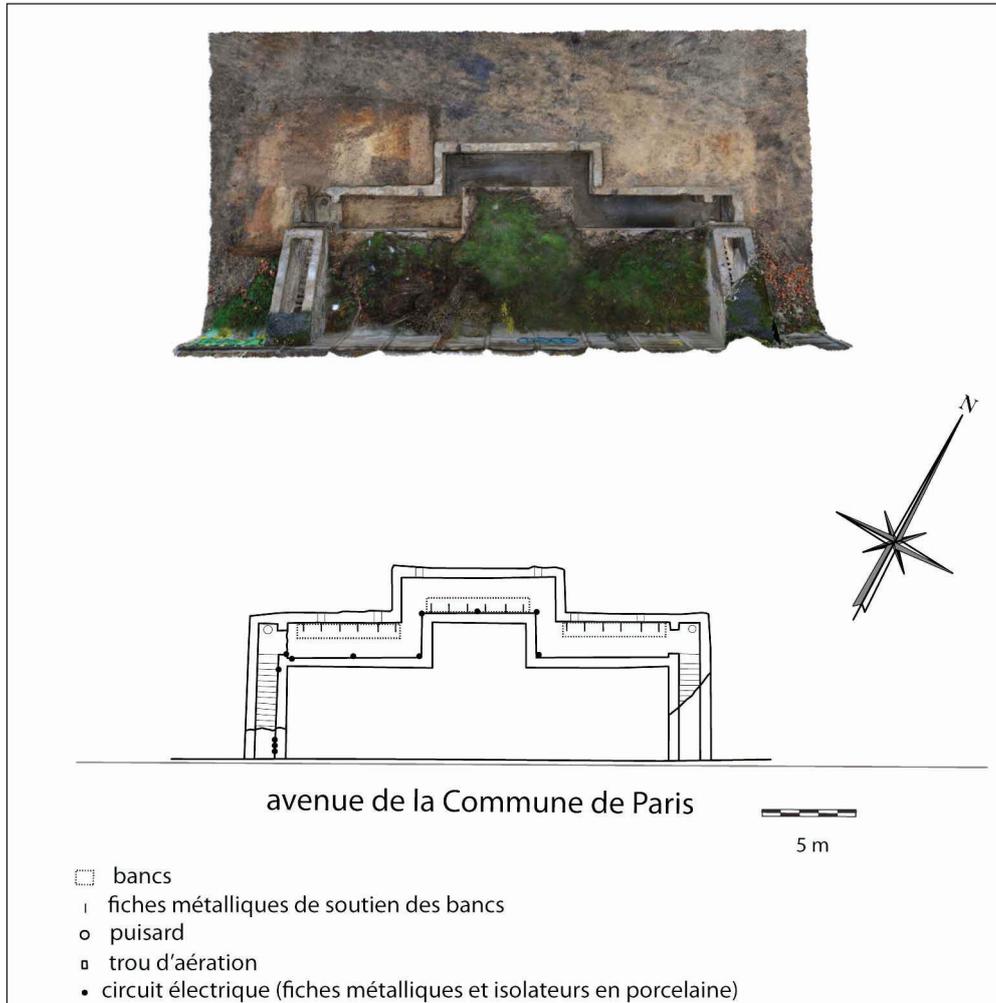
photogrammétrie et plan de la tranchée-abri. © M. Belarbi, N. Samuelian, Inrap.
